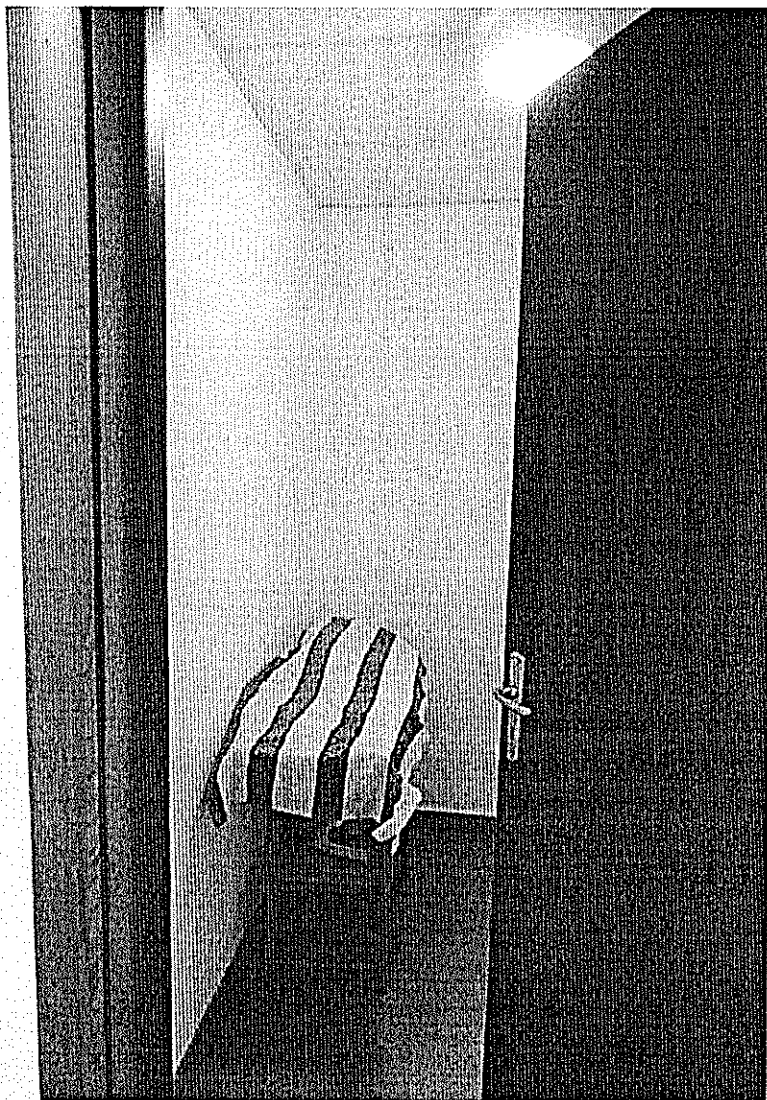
Deposito nell'ala nord del primo corpo di fabbrica – piano primo.
